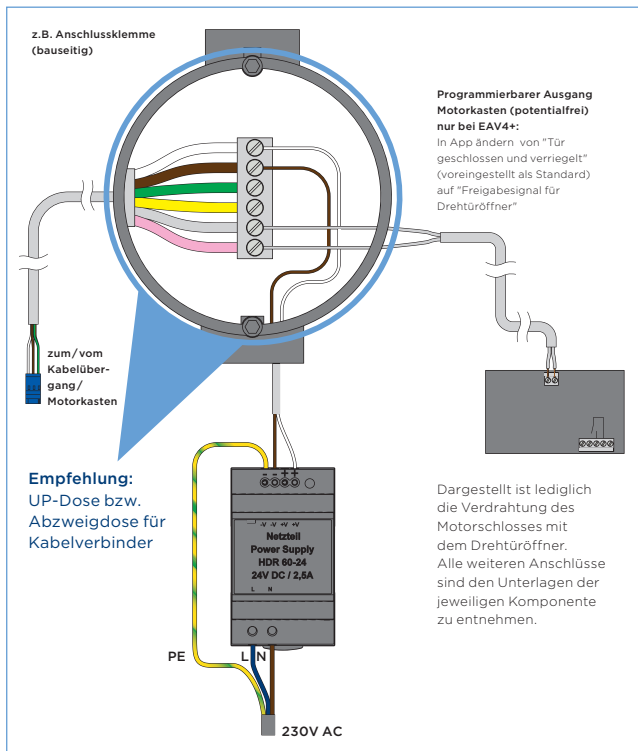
Allgemeiner Anschlussplan mit Drehtüröffner
